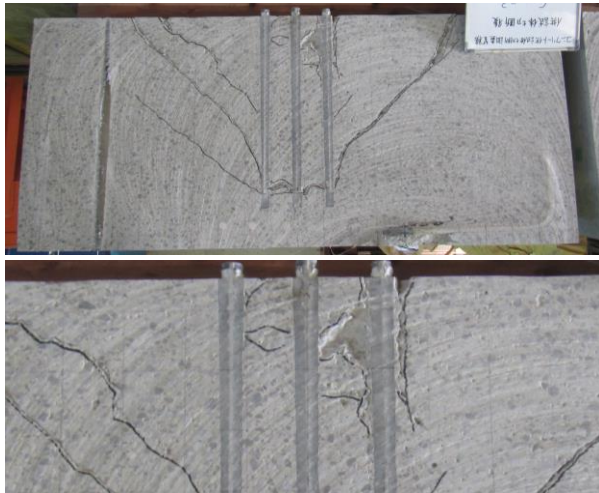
試験終了後のフーチング上面のひび割れ状況
